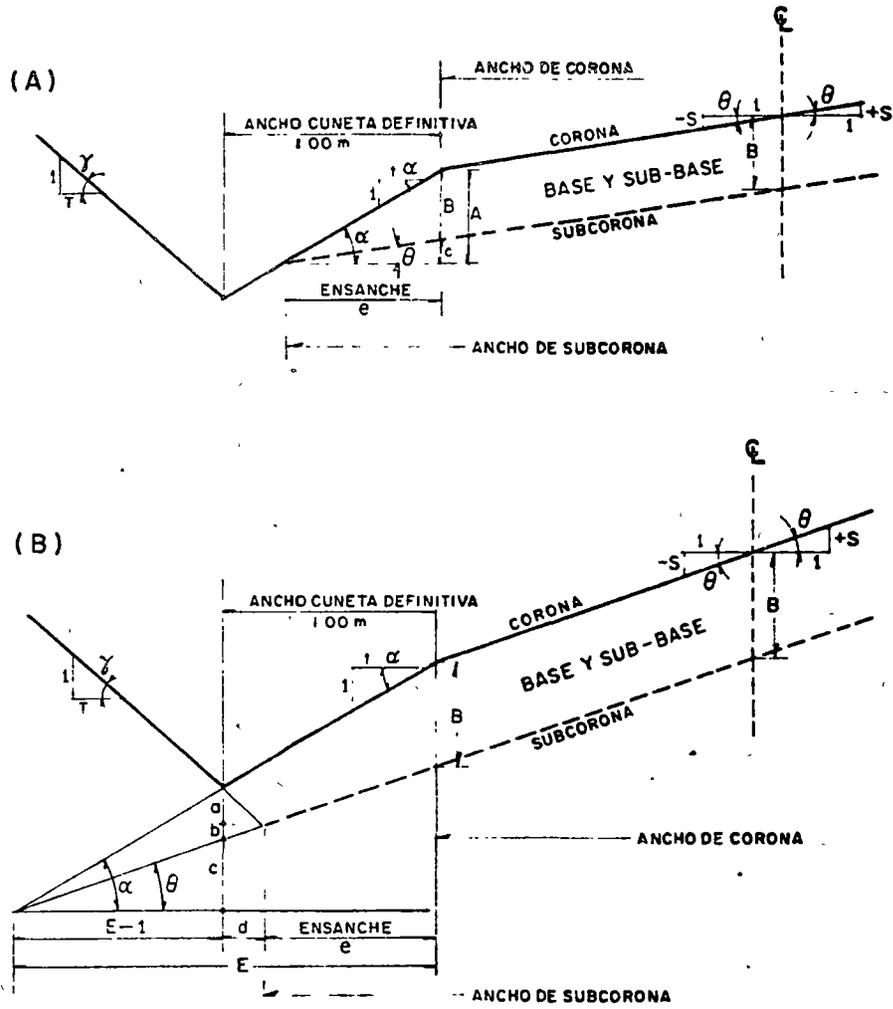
ENSANCHAMIENTO DE LA SUBCORONA
